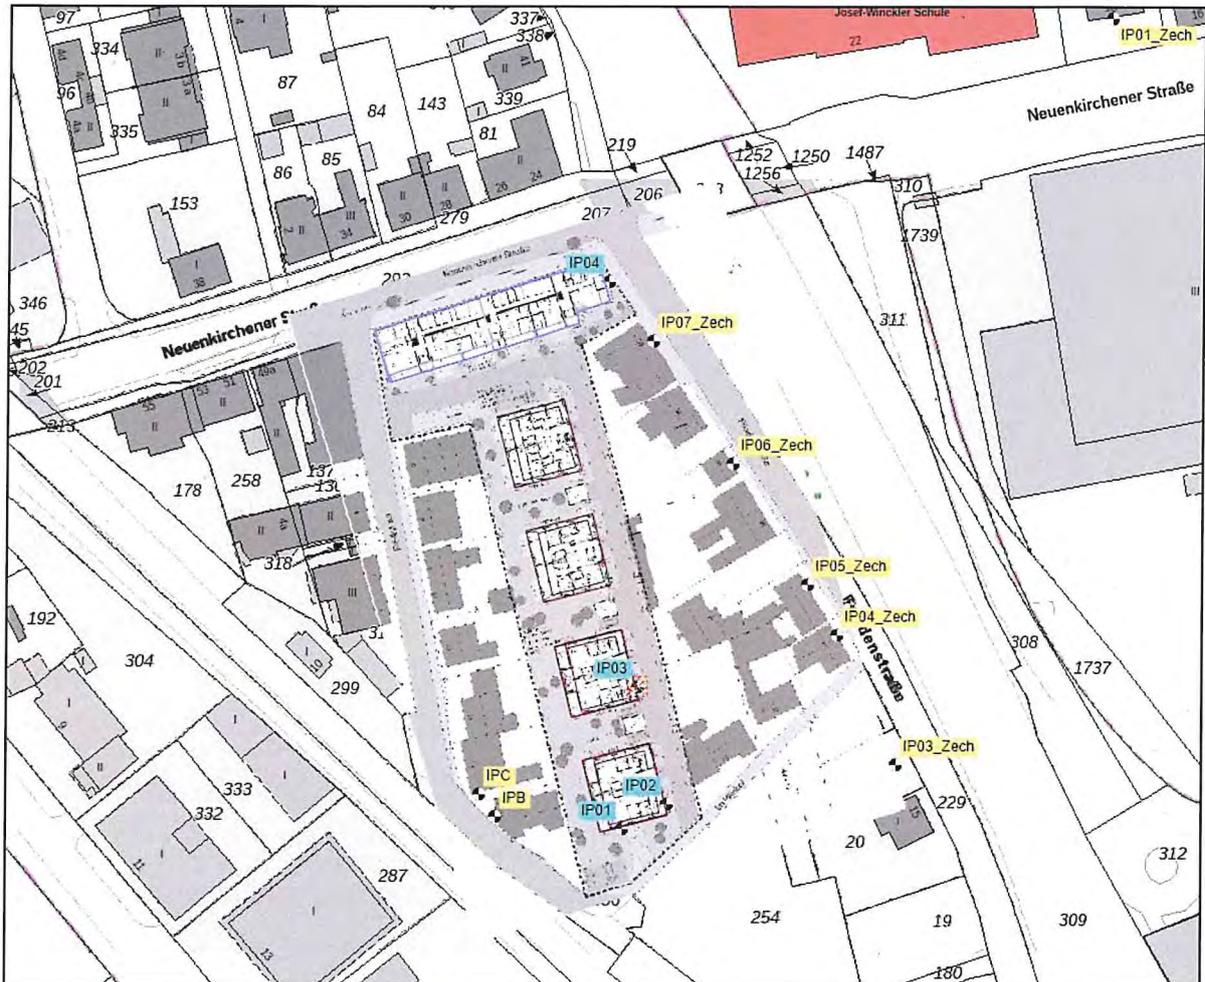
Lage der betrachteten Immissionsorte Bestand (gelb) und Planung (türkis)
